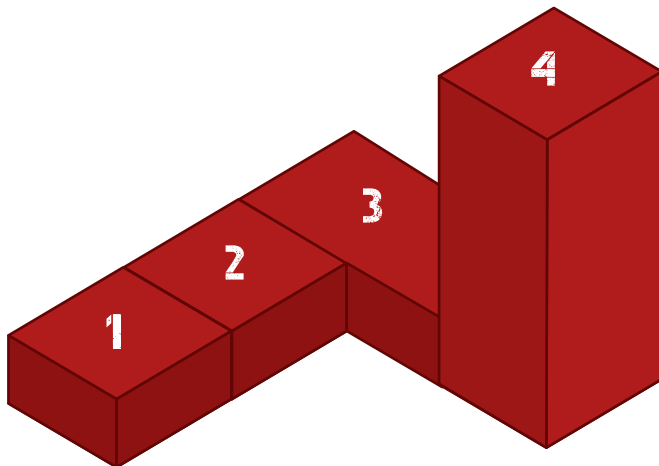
Division d'un bâtiment en sections, pour pallier les différences de tassement du sol.
